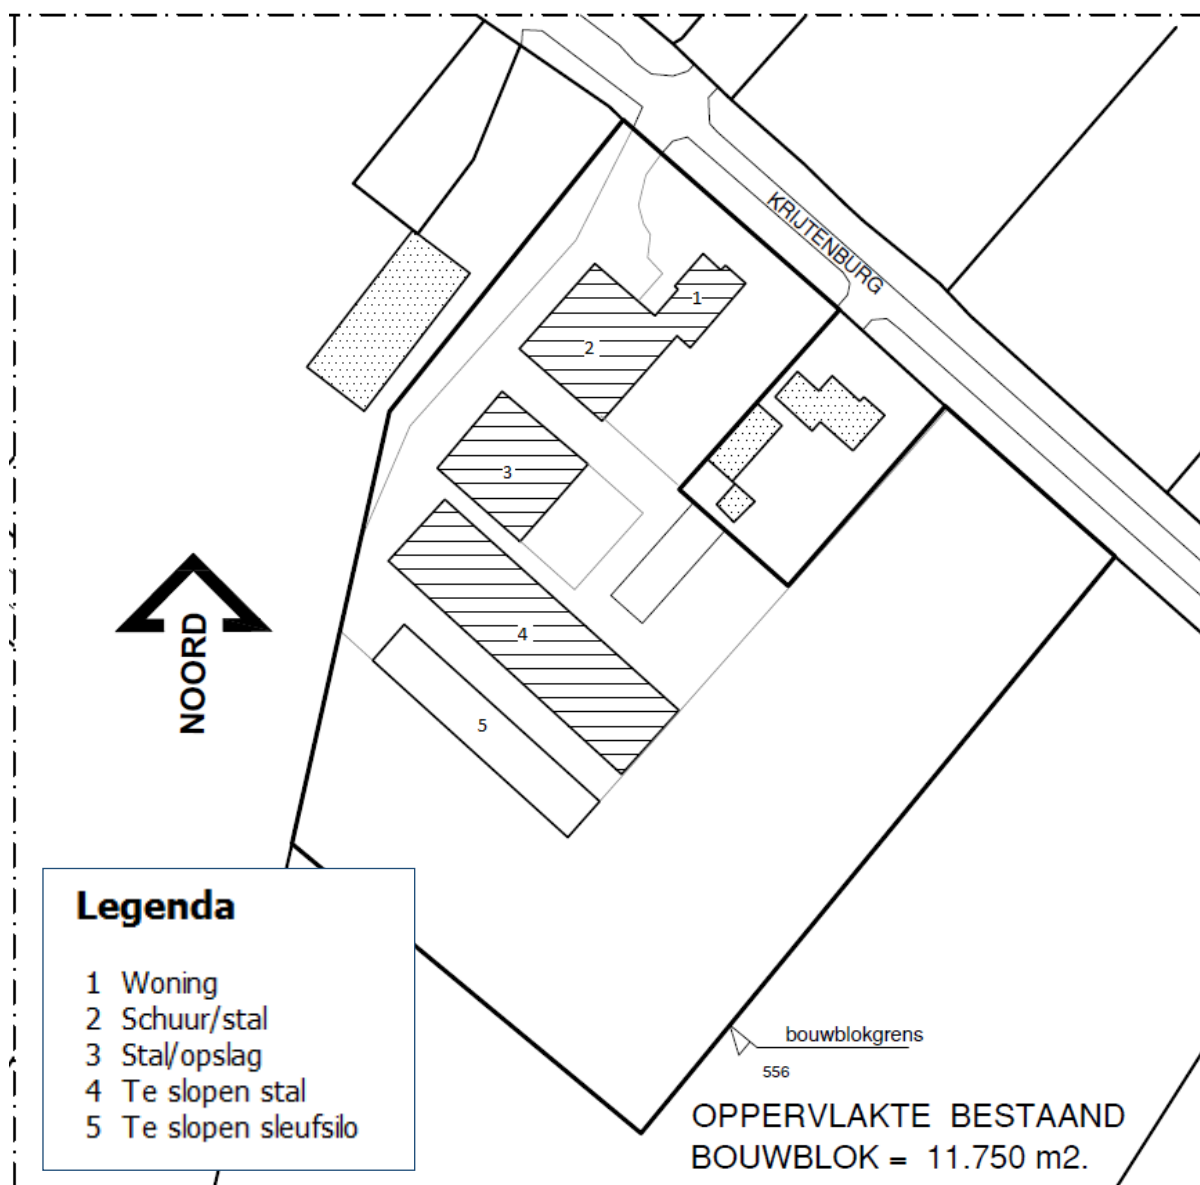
Bovenaanzicht bedrijf, bron: ruimtelijkeplannen.nl
